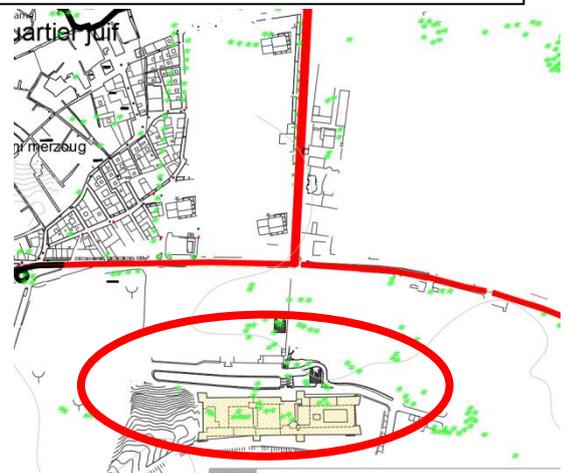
Vue en plan sur l'hôtel du M'Zab.
